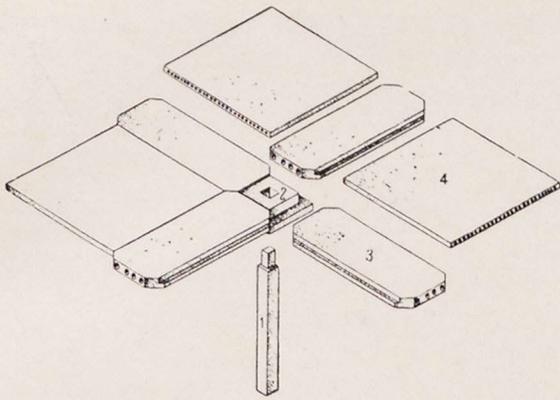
Основные конструкции безбалочных перекрытий: 1 — колонна; 2 — капитель; 3 — надколонная панель; 4 — пролетная панель
